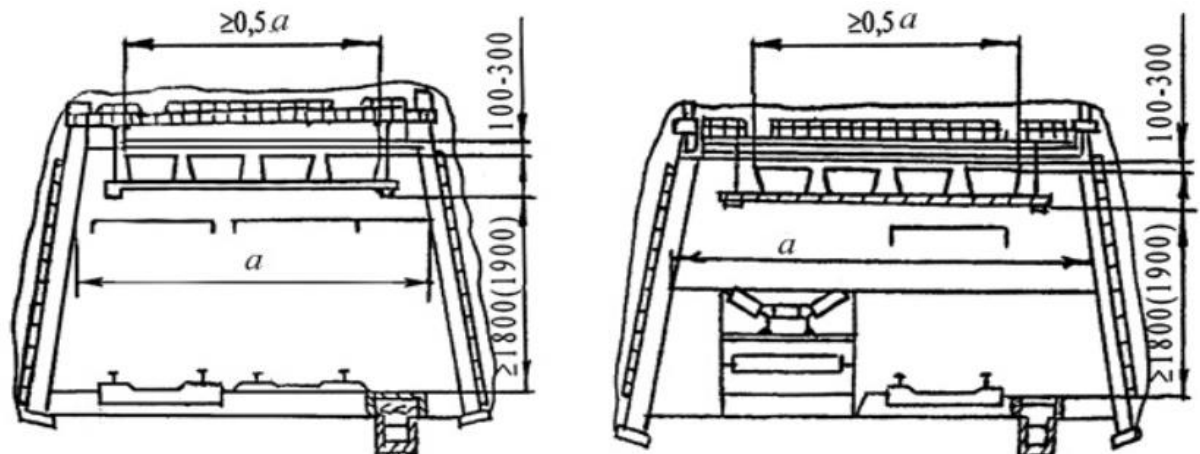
Схема крепления водяного заслона в горной выработке
